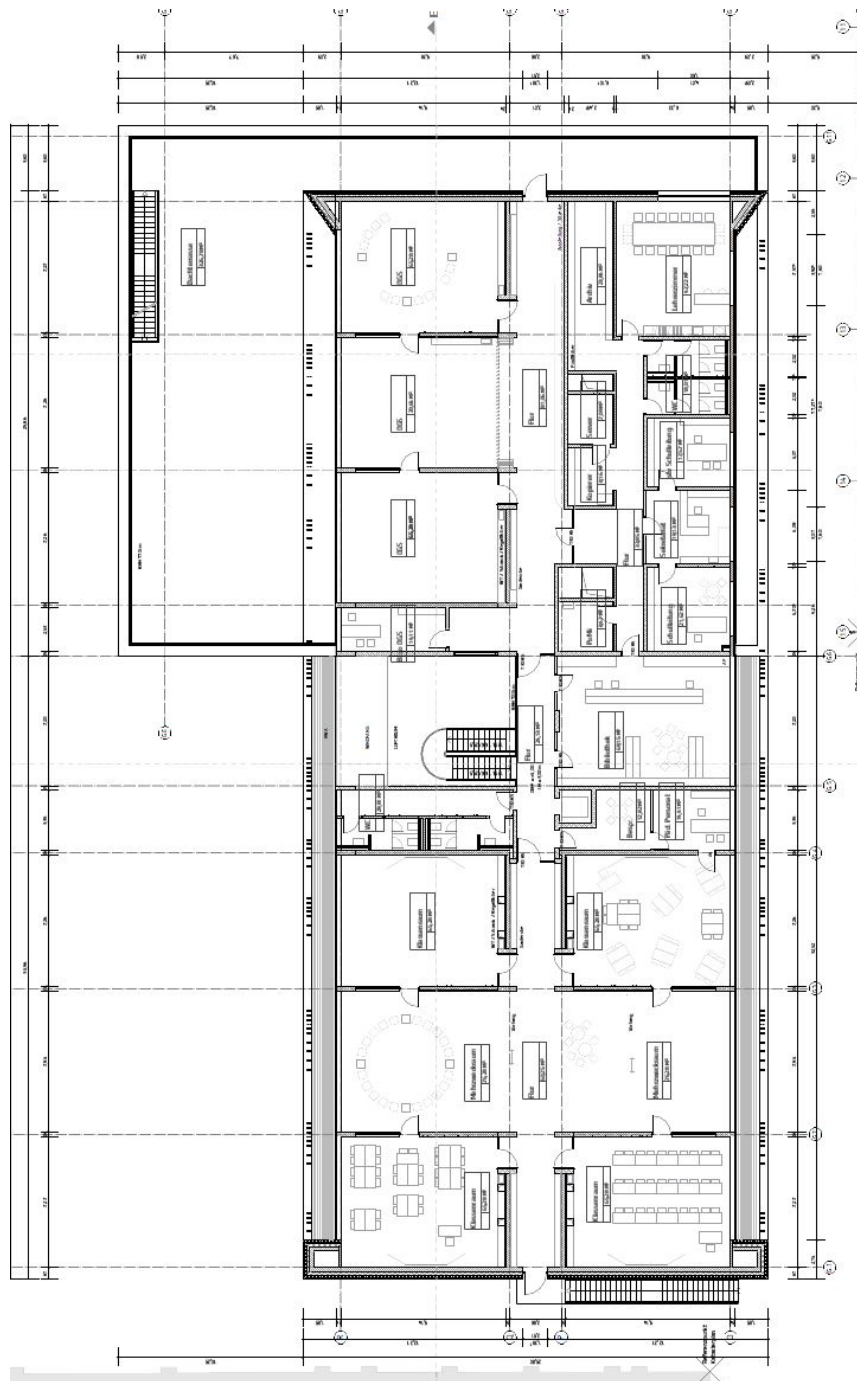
Grundriss Erdgeschoss Neubau einer 2-zügigen Grundschule mit Mensa
